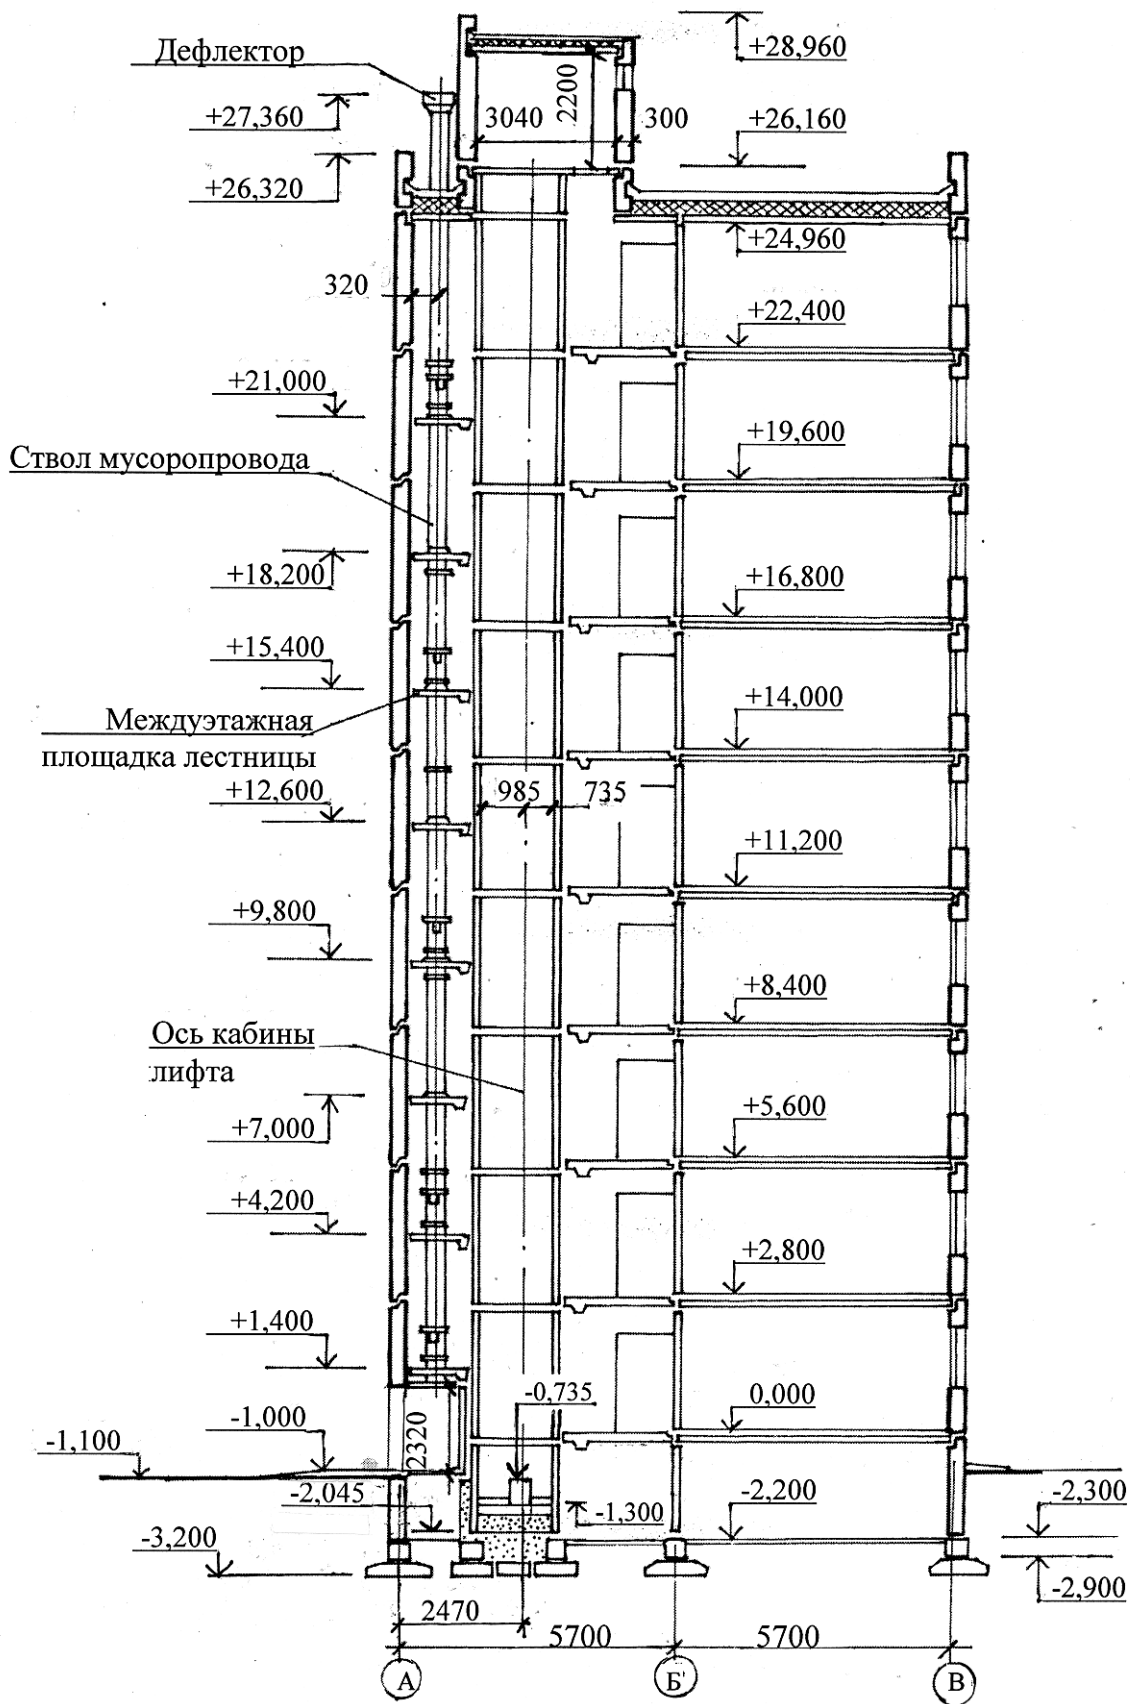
Пример выполнения поперечного разреза по лифтовой шахте и мусоропроводу (вариант - без чердака)
